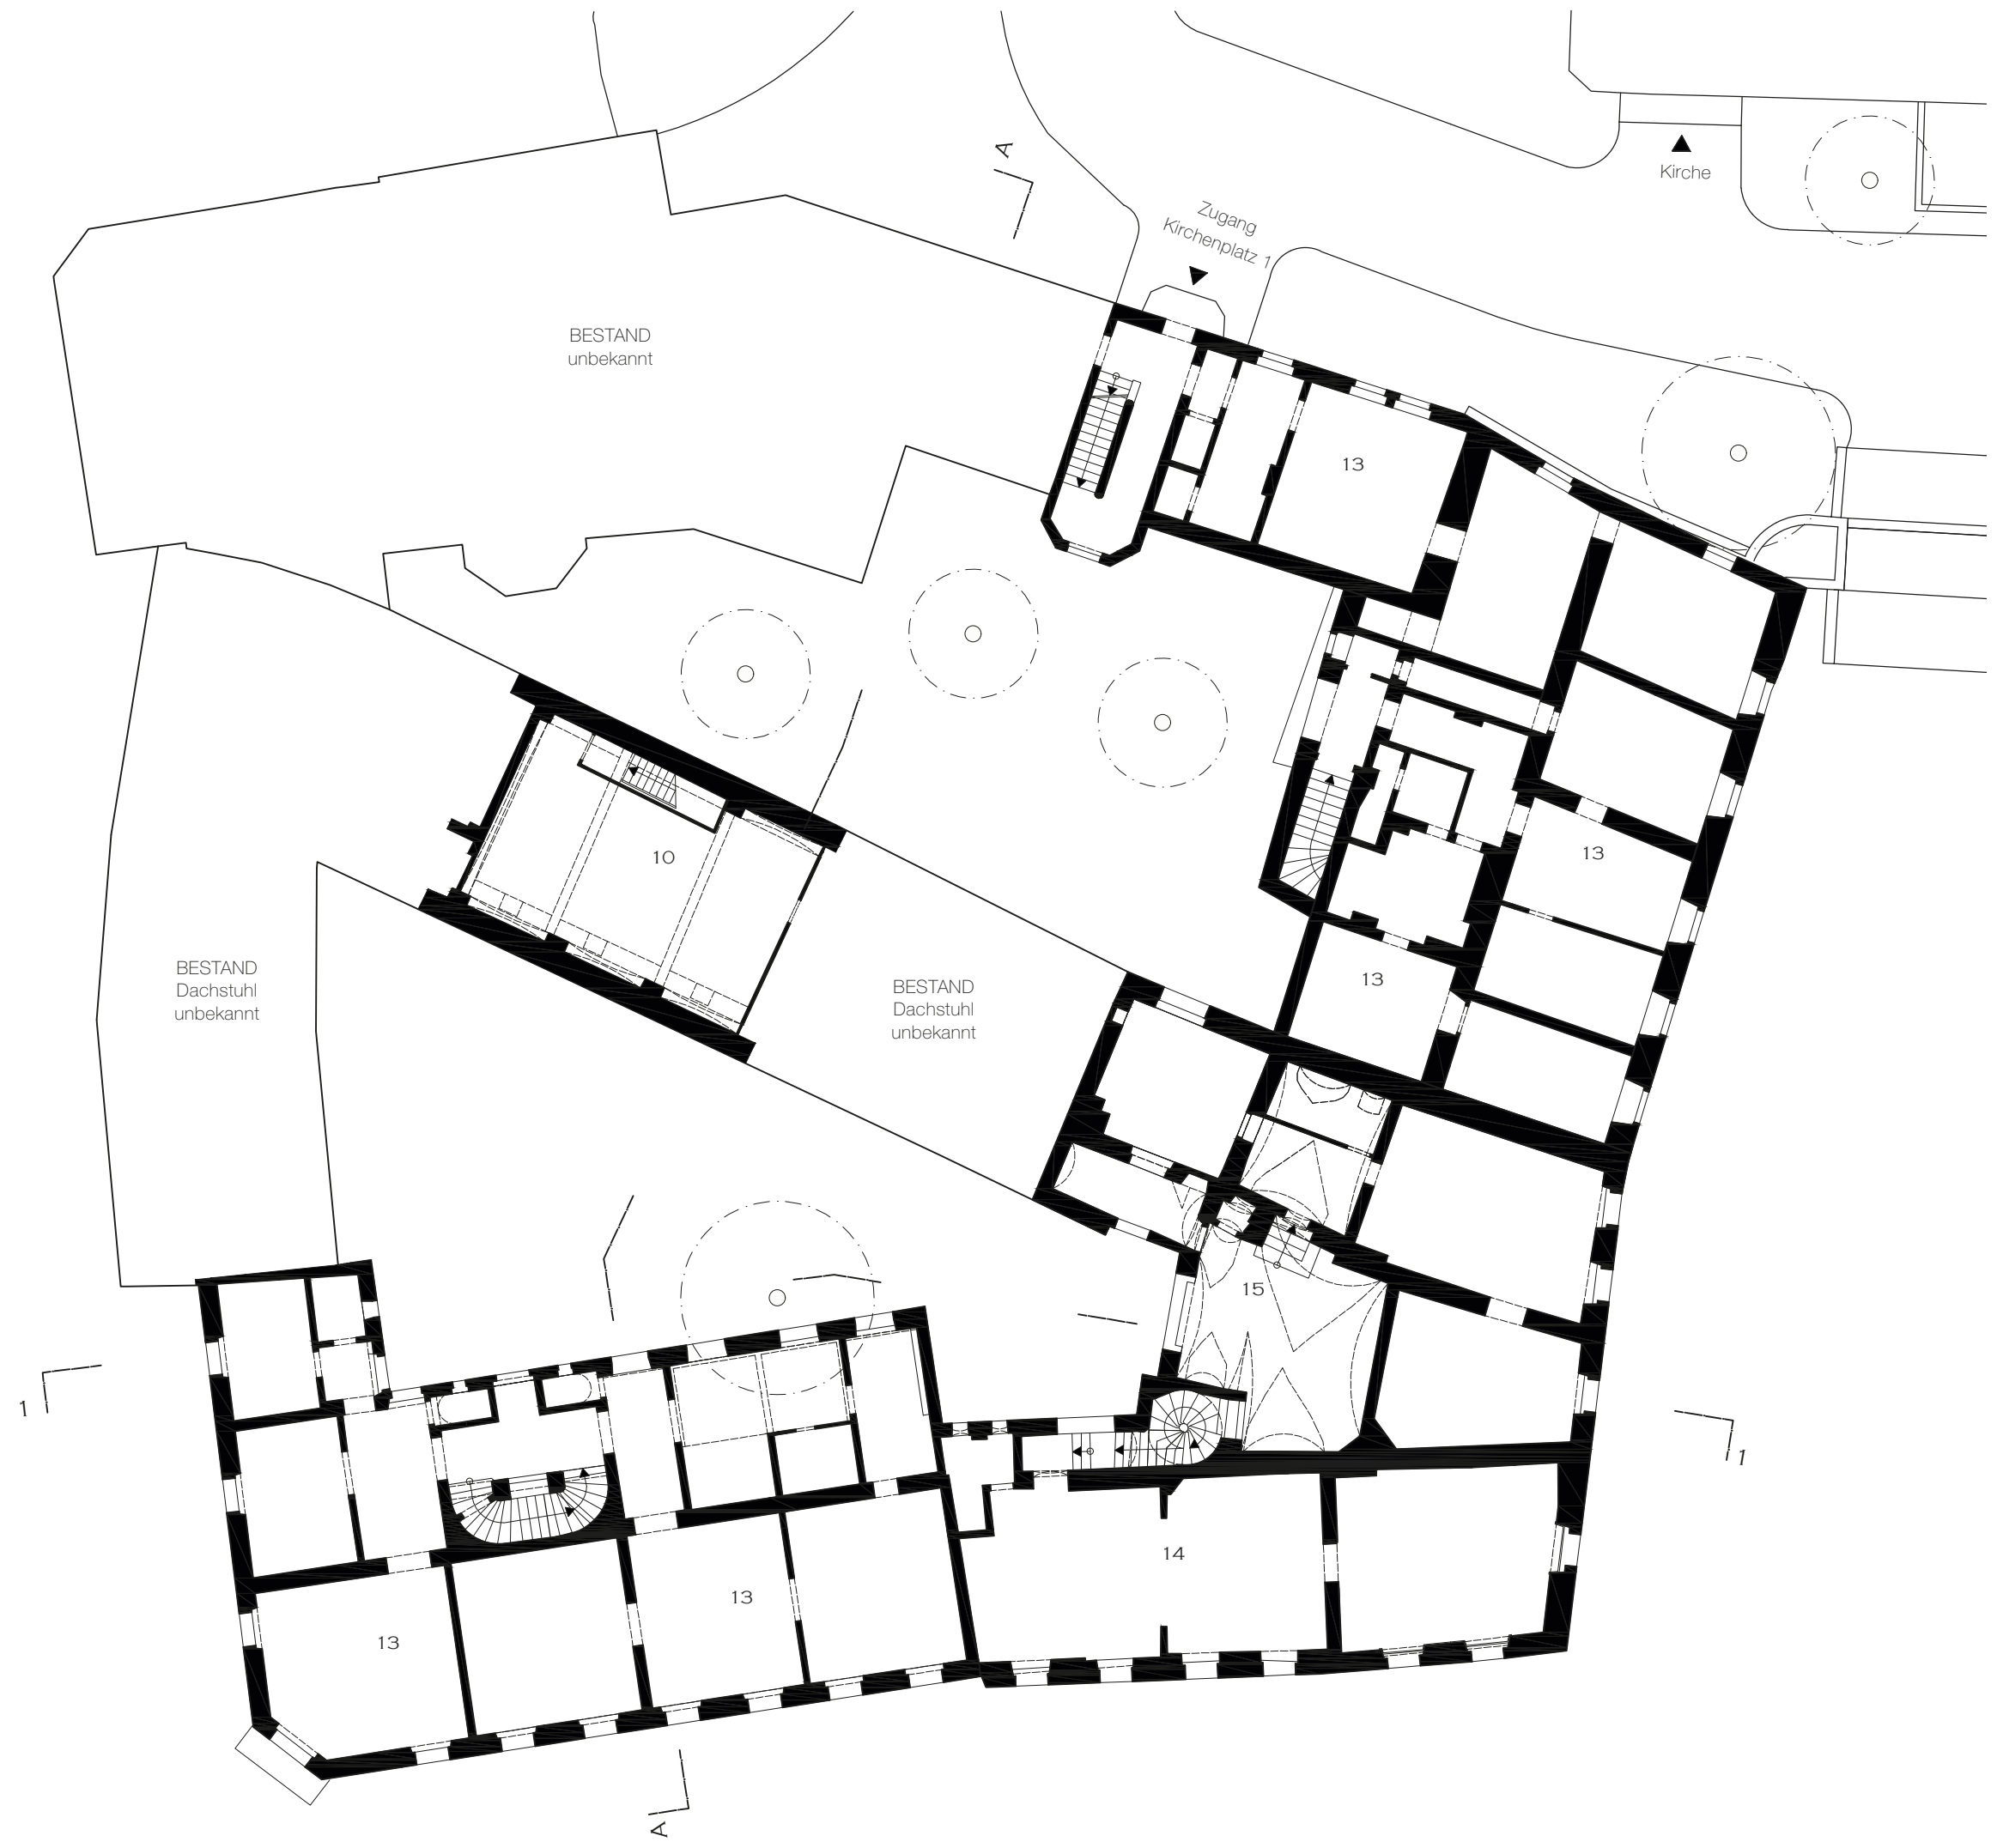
Bestandsplan, Grundriss Erdgeschoss
